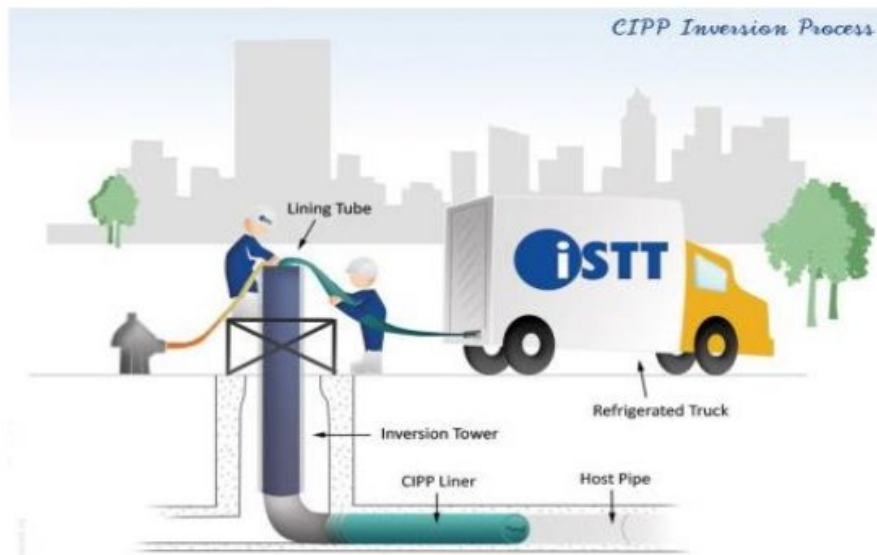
Curado de la tubería in situ (*Cured in place pipe*). Tomado de *The International Society for Trenchless
